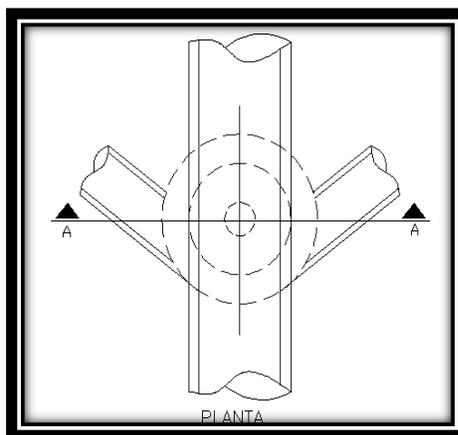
Diseño en planta para pozos de conexiones oblicuas, (Ref. 7)
